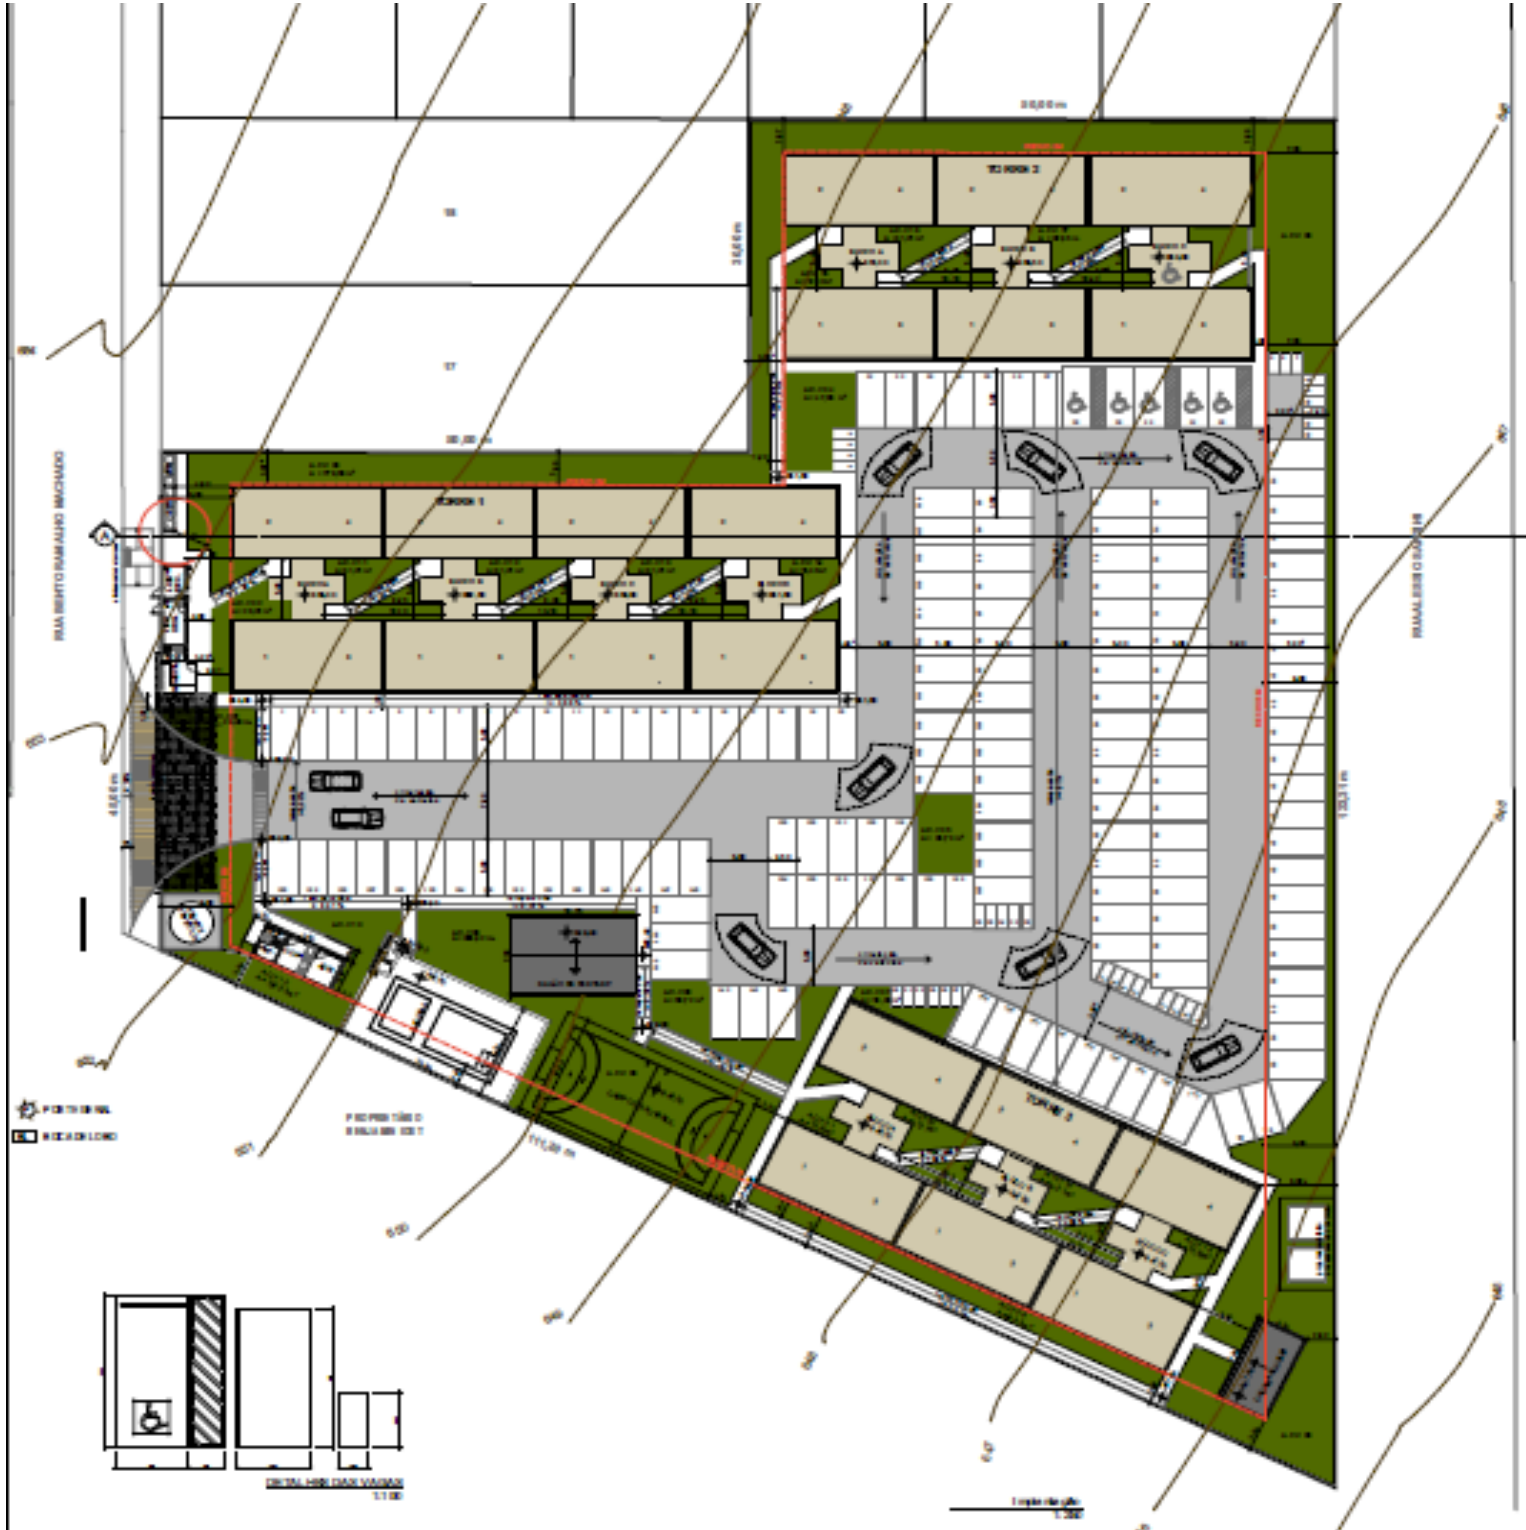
Planta de implantação da obra 2 (pesquisador,2019)
